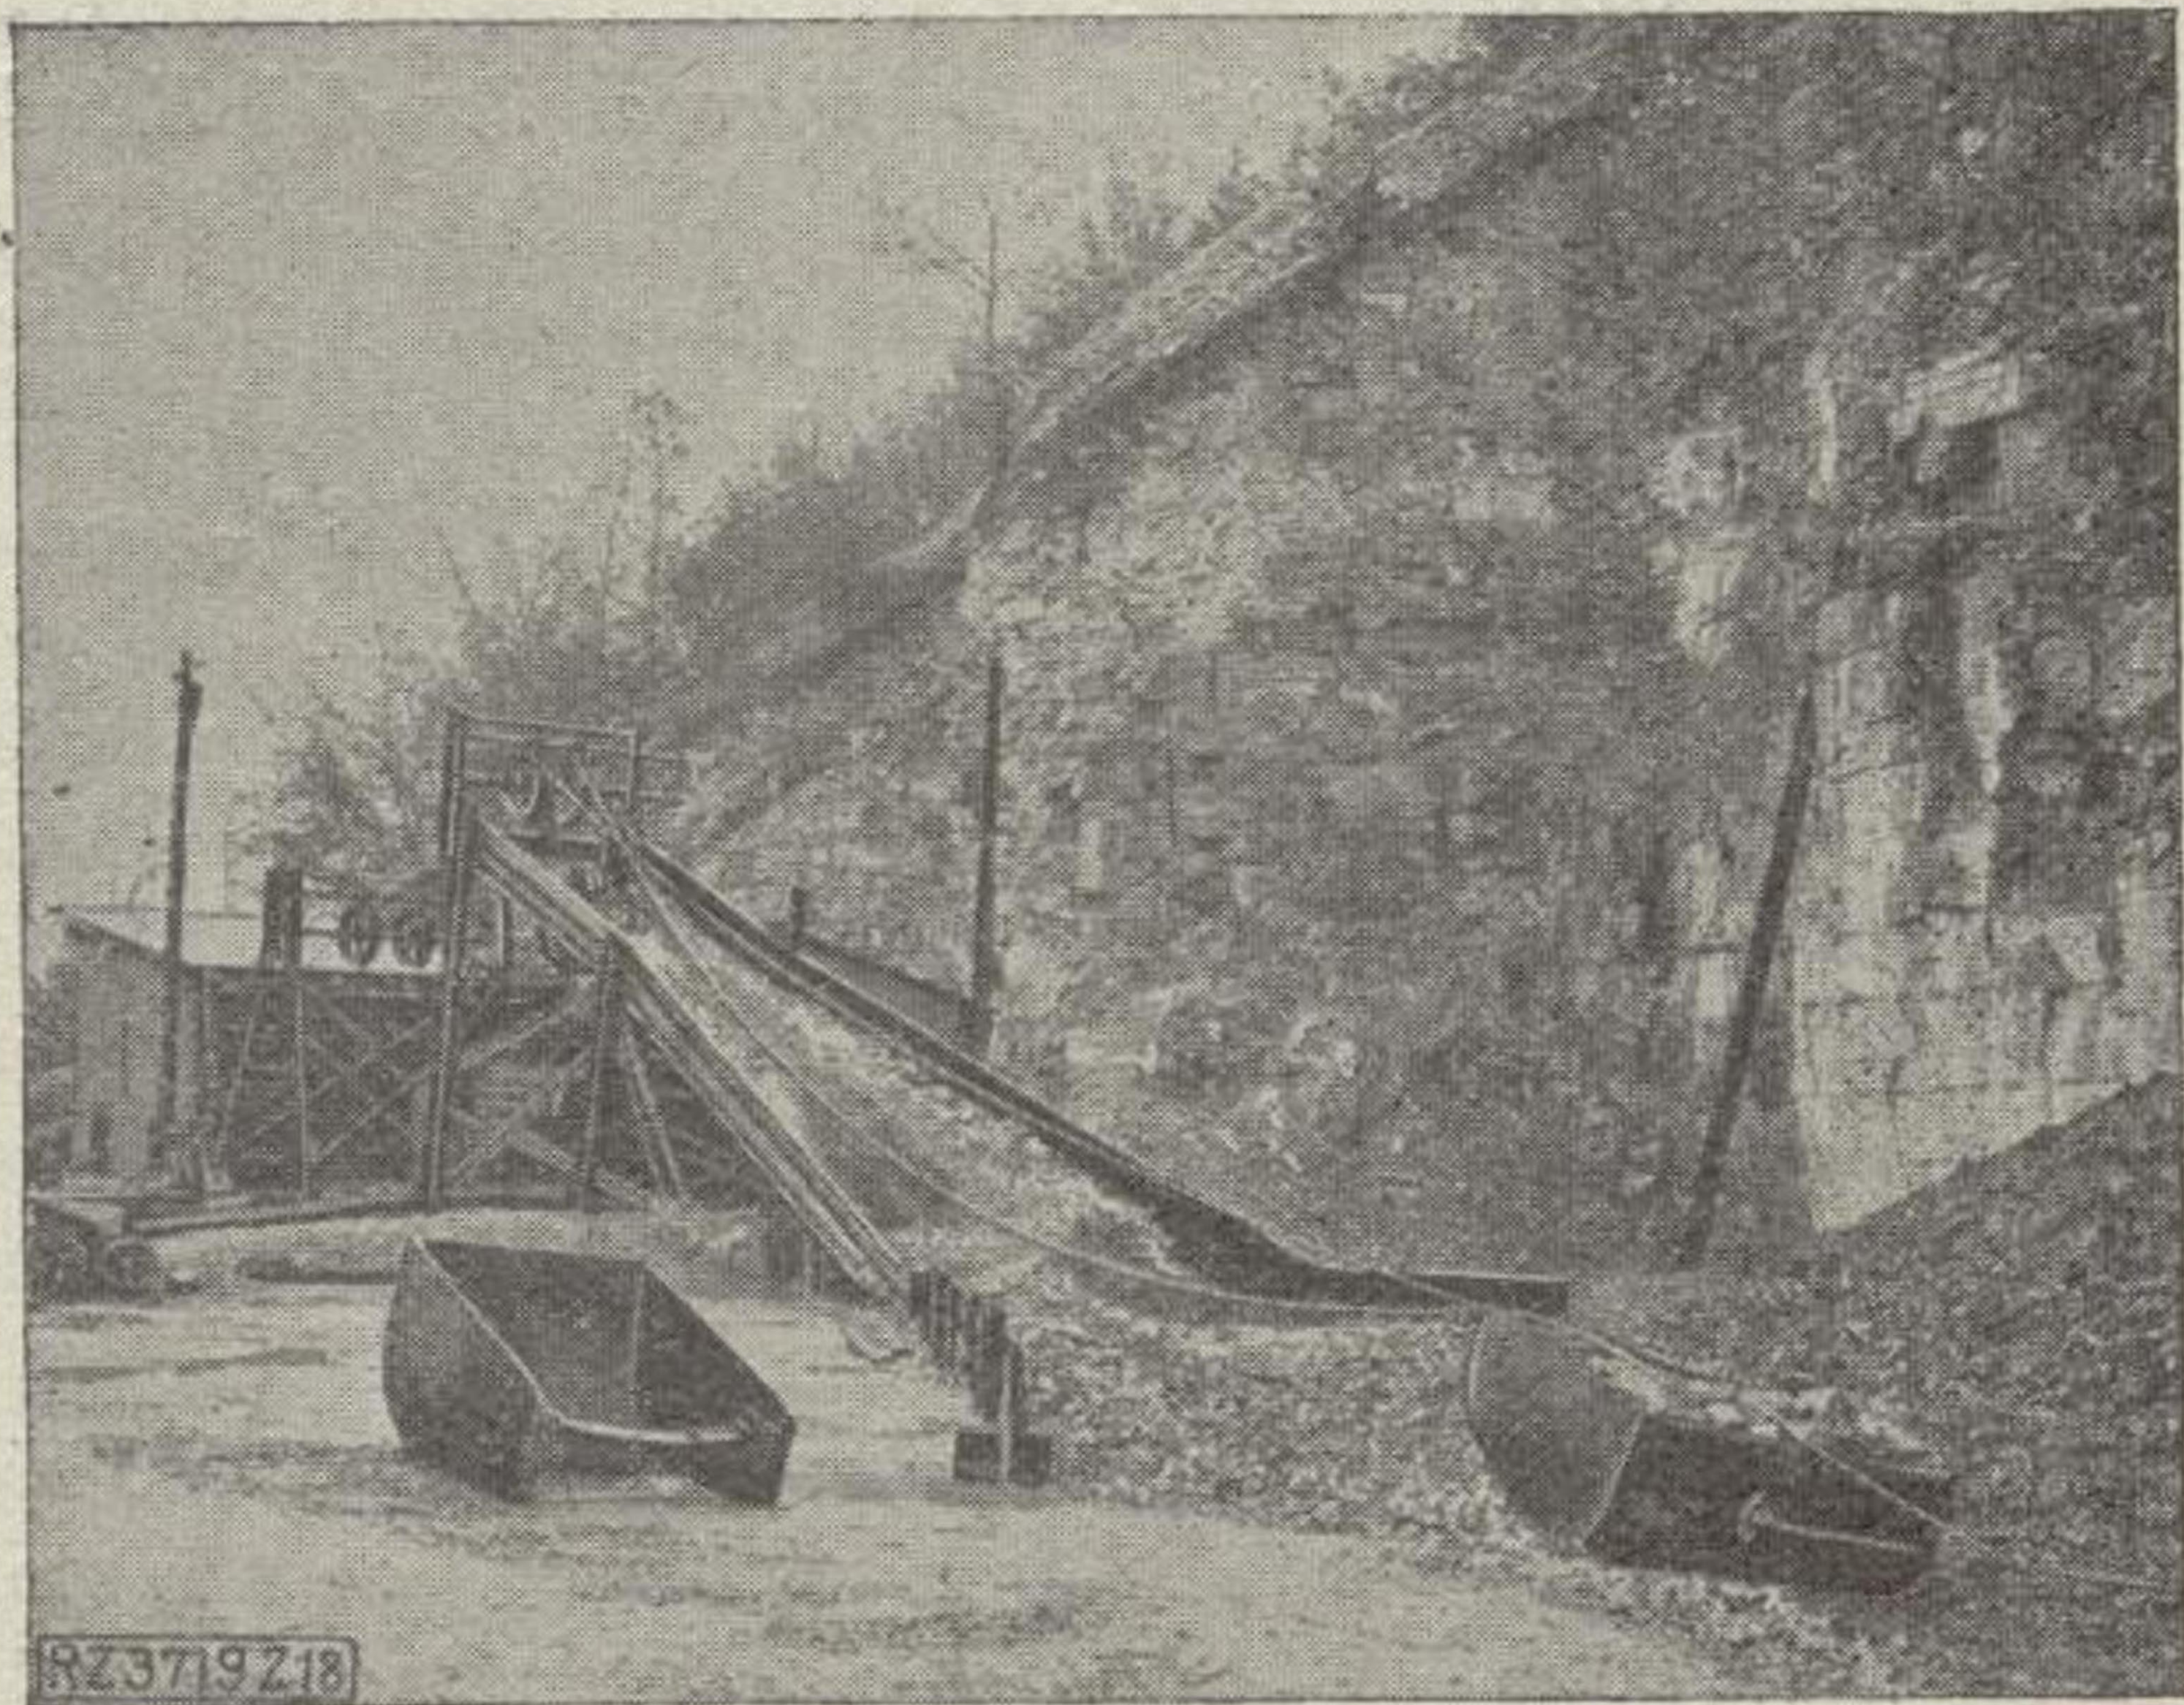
Plano inclinado con emparrillado de barrotes.
